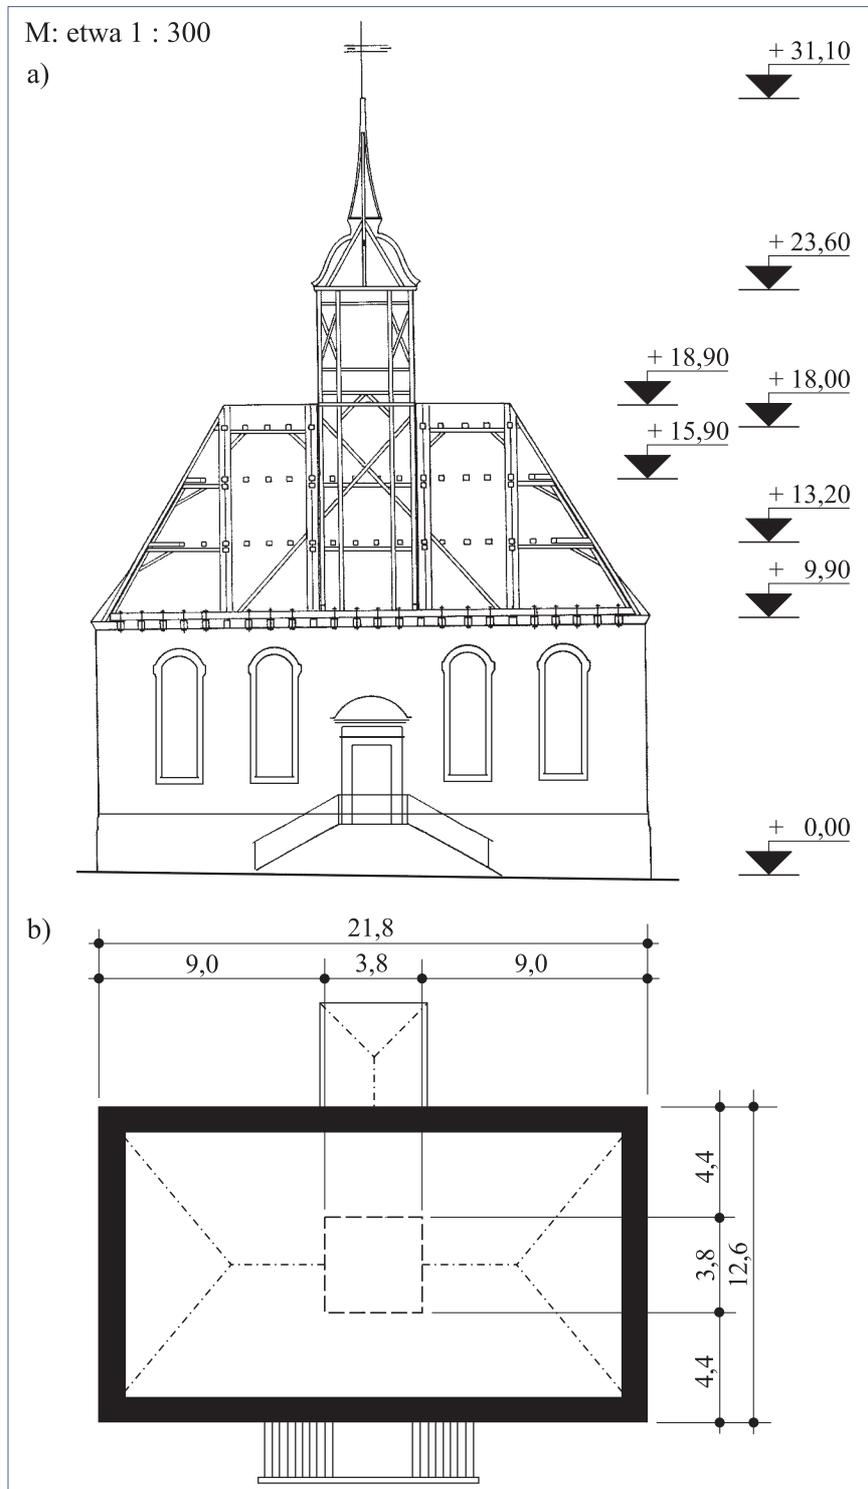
Weinbergkirche zu Dresden - Pillnitz – Geometrie des Bauwerks.
